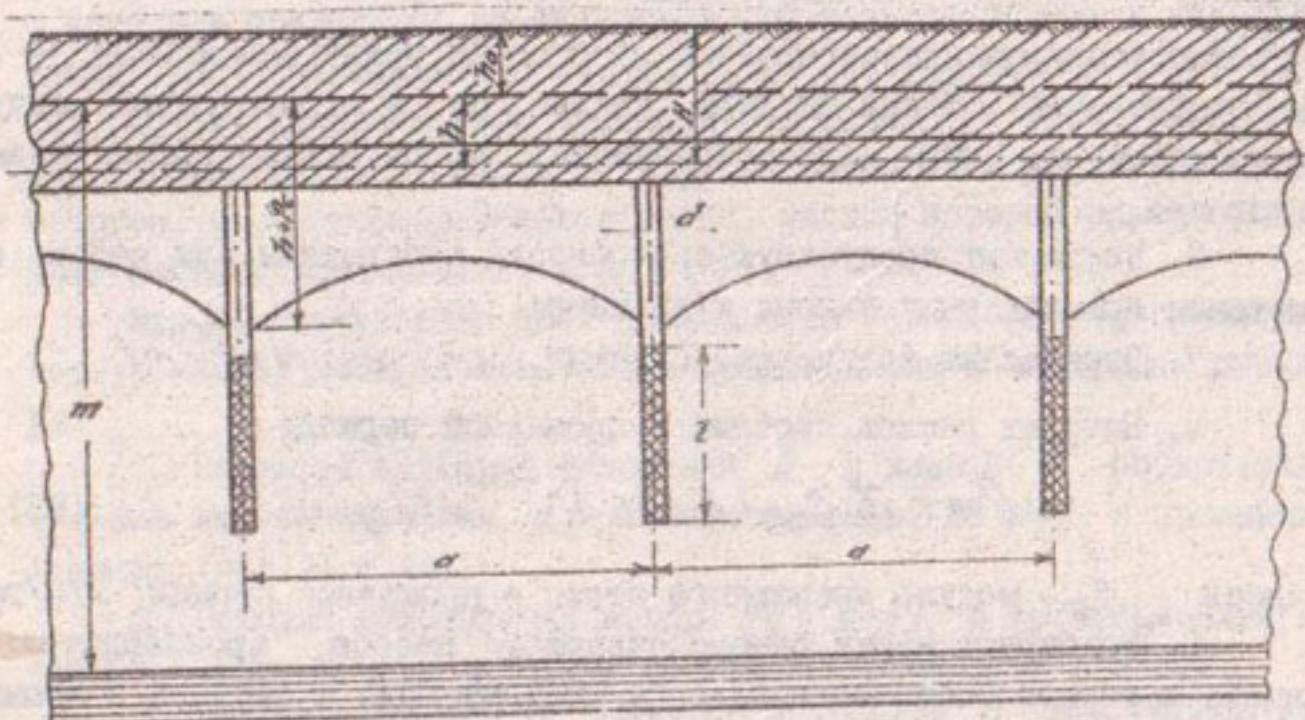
Схема к расчету расстояний между вертикальными дренами.
